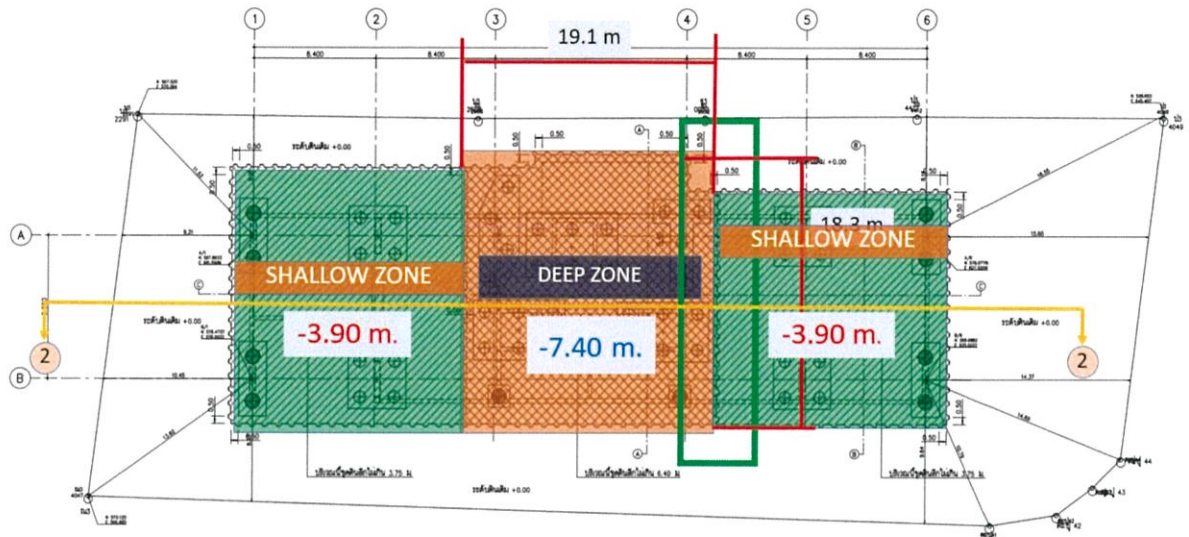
Plan ระดับการขุดดินของ Deep Zone Layer 1
